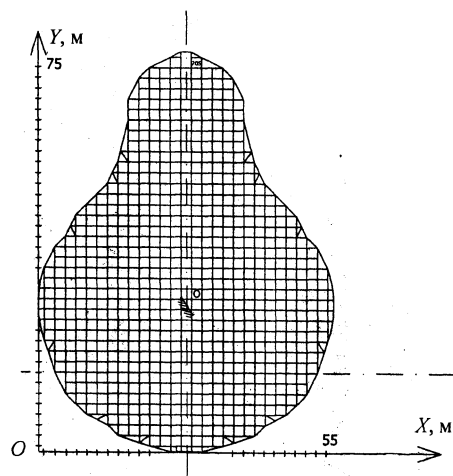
Принятая при расчете разбивка фундаментной плиты на участки Б. Н. Жемочкина
